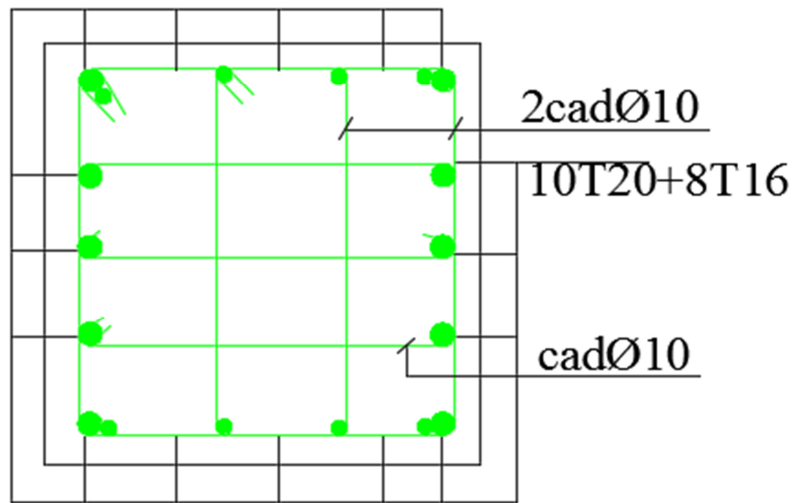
Schéma de ferraillage de poteau (40X40) cm
